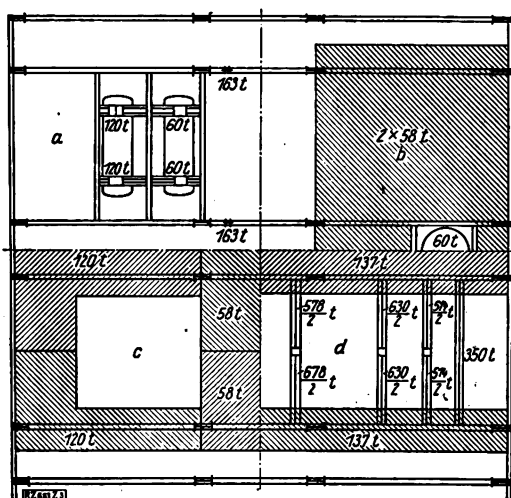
Teil des Kesselhaus-Grundrisses mit eingezeichneten Lasten.
